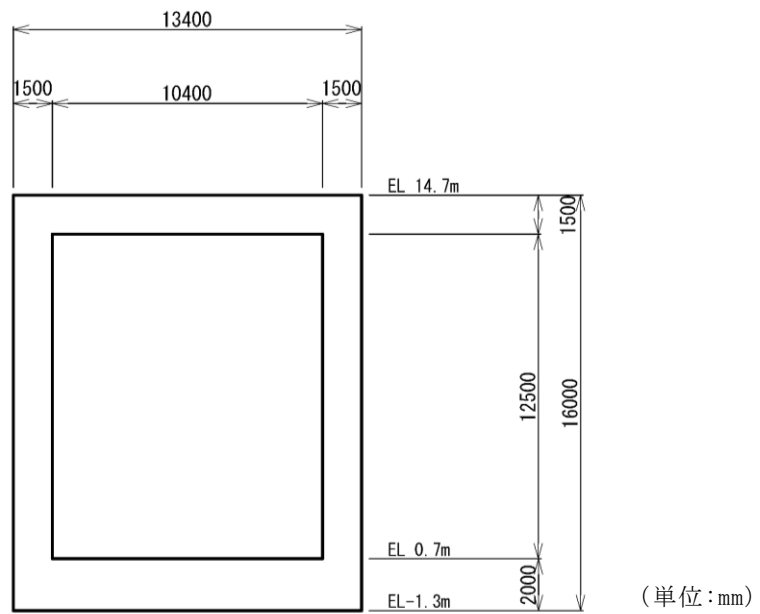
低圧原子炉代替注水ポンプ格納槽 断面図 (B-B 断面)
